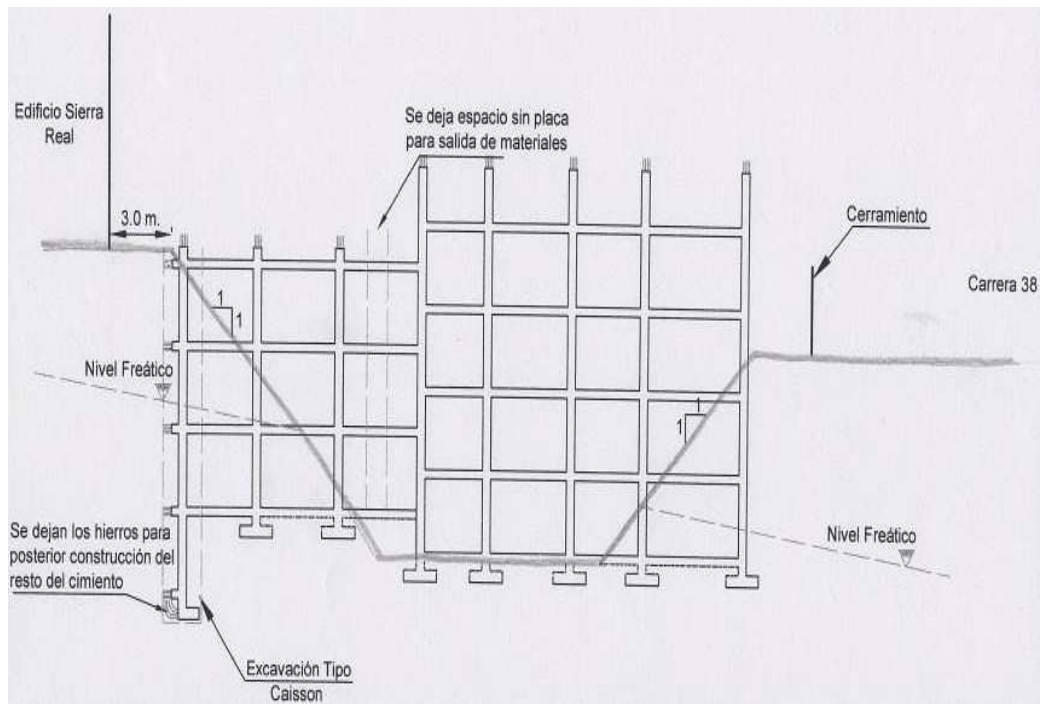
Diagrama 7 Construcción cimentación, Estudio geotécnico de suelo.
